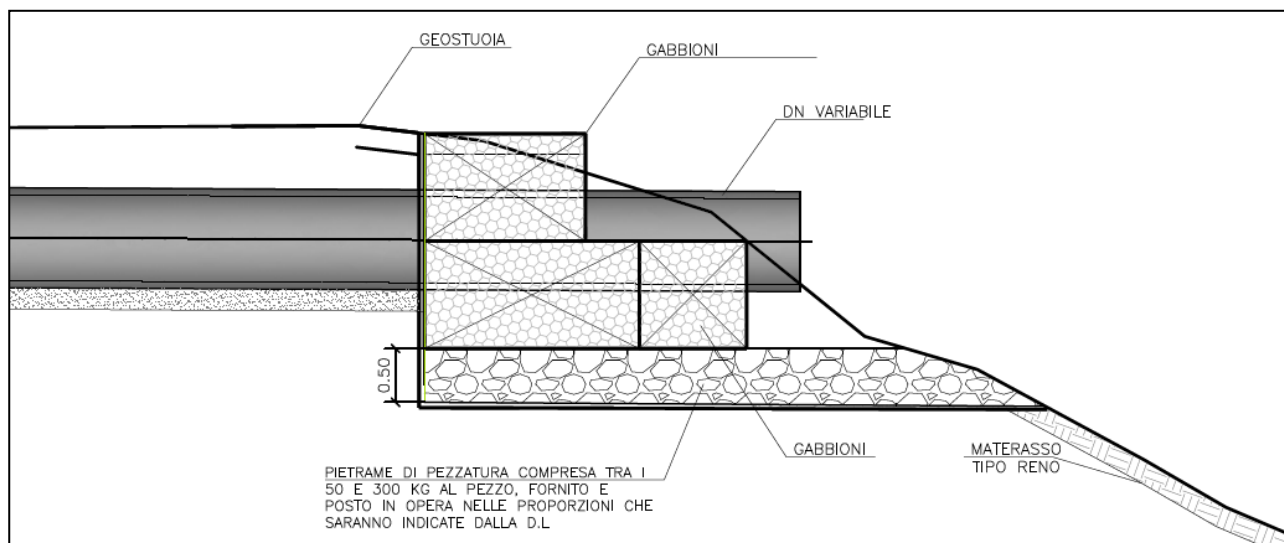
Sistemazione tipo spondale scarico. Sezione tipo condotta scarico.
